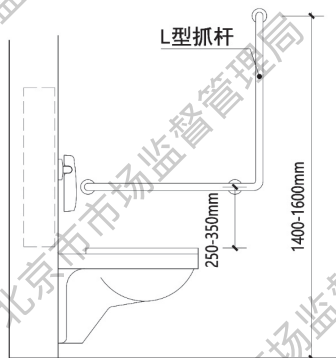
无障碍坐便器 L 型安全抓杆设置侧立面图
